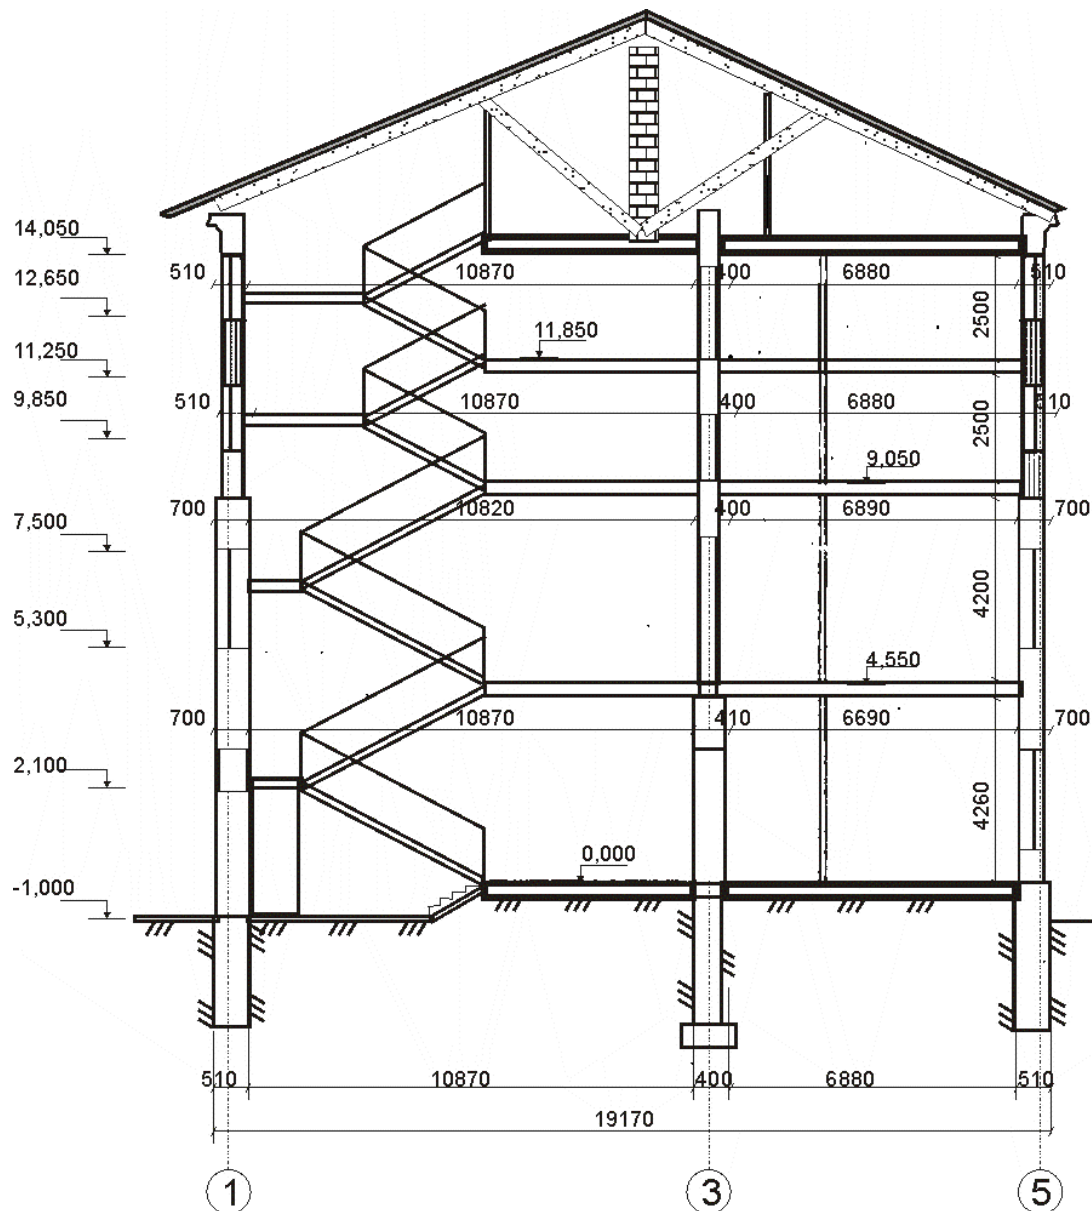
13 – Поперечний розріз реконструйованої будівлі
